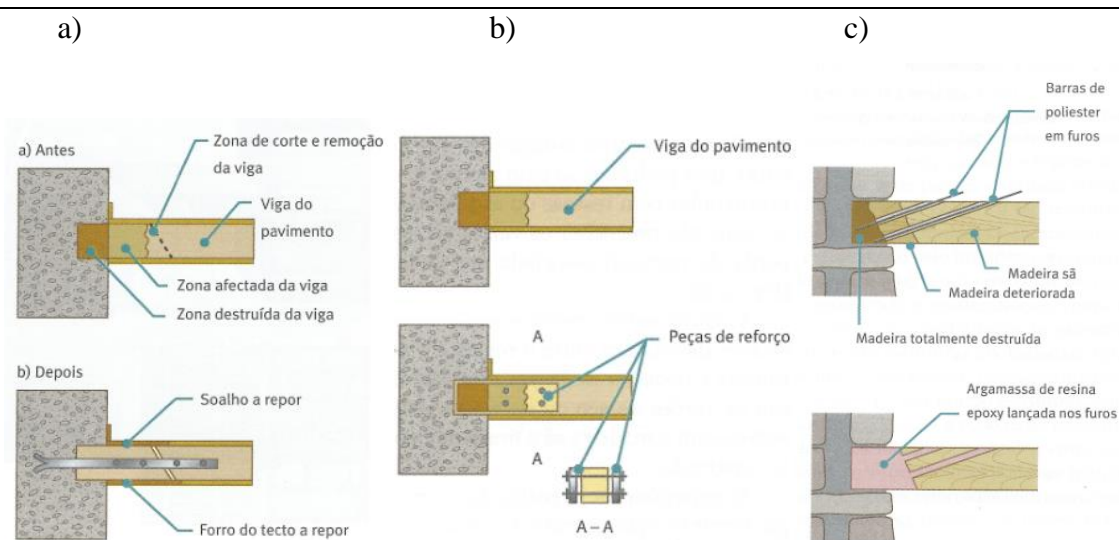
a) Substituição de topo de viga de madeira [7]; b) Reforço de viga por empalme lateral [7]; c) Injeção de resina epoxy para reconstituição de zona deteriorada de viga de madeira [7]
